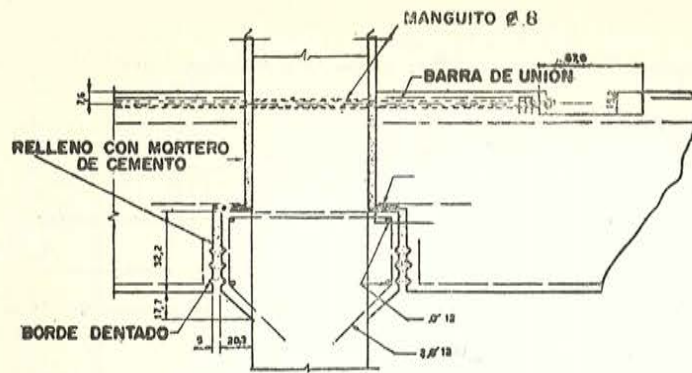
Unión de dos vigas contiguas de una planta tipo al soporte.
